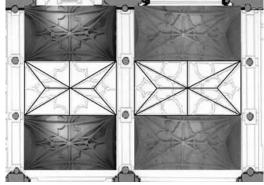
Configuración y esquema de trazado de las bóvedas de las capillas perimetrales
